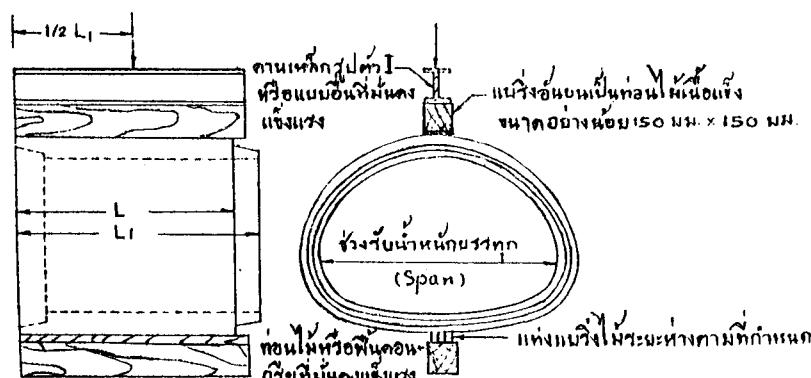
การทดลองท่อแบบป่ากลืนร่างโดยวิธี THREE-EDGE BEARINGS
